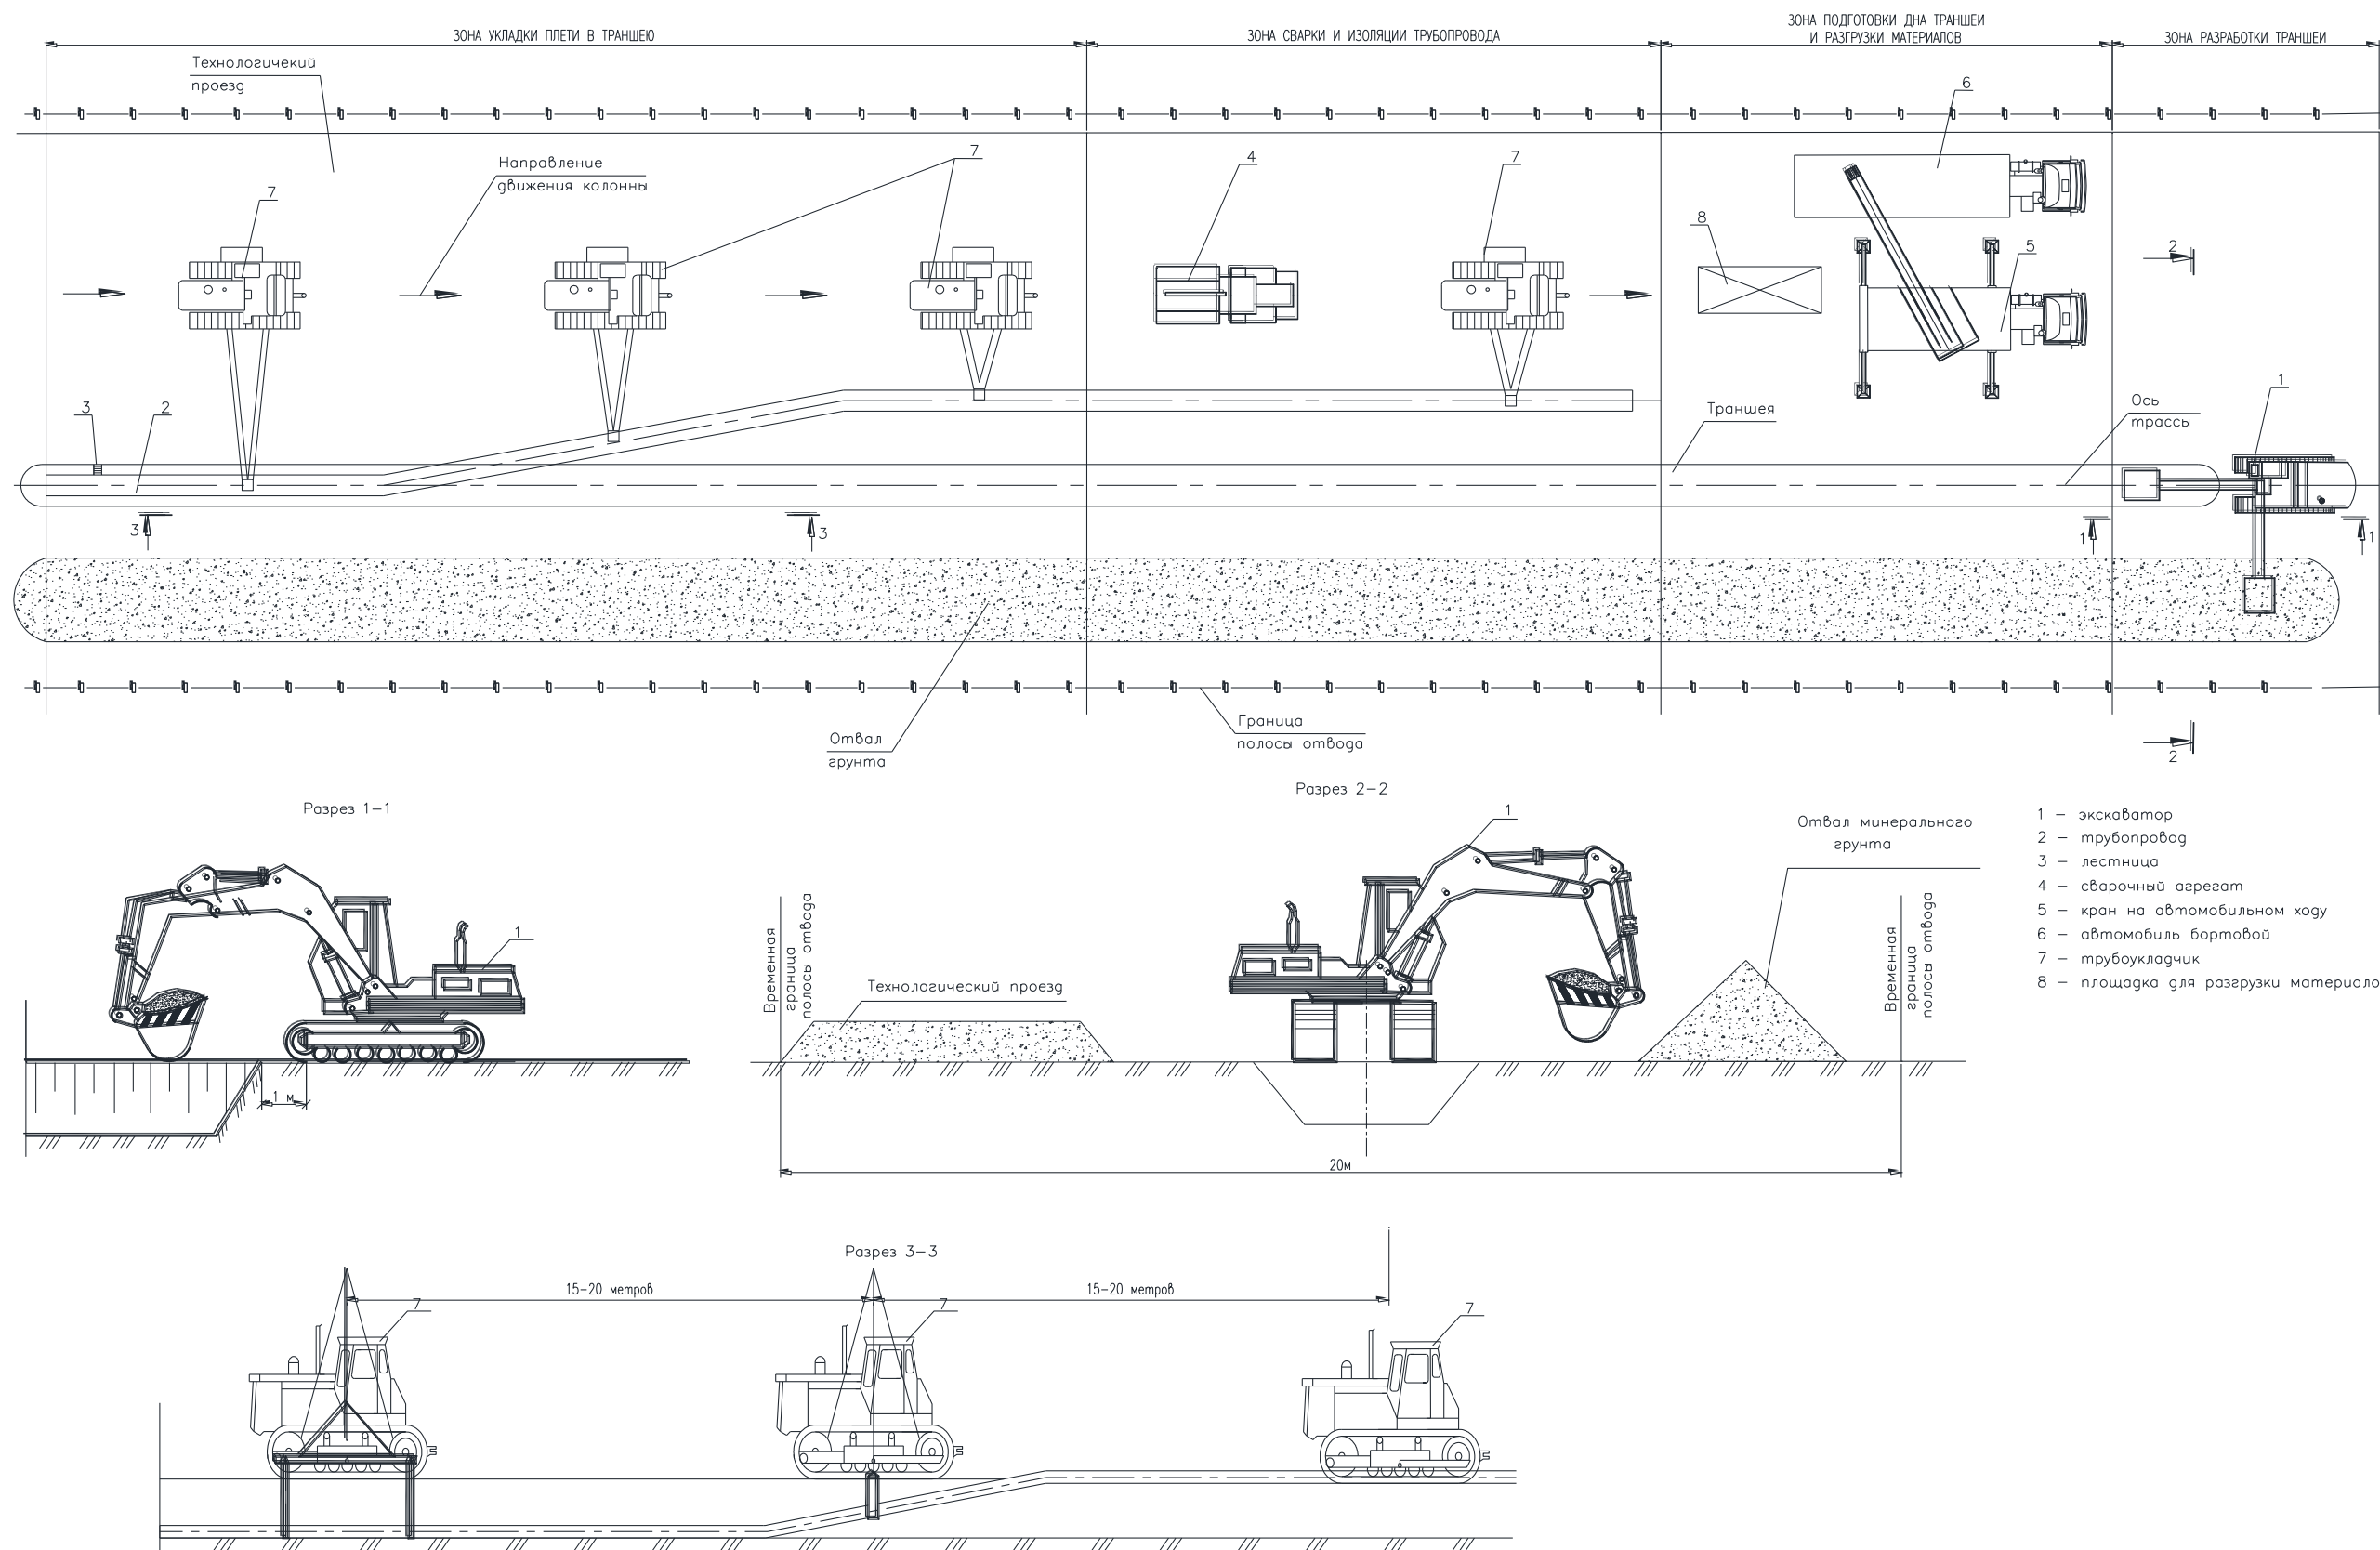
Типовая технологическая схема монтажа трубопровода
